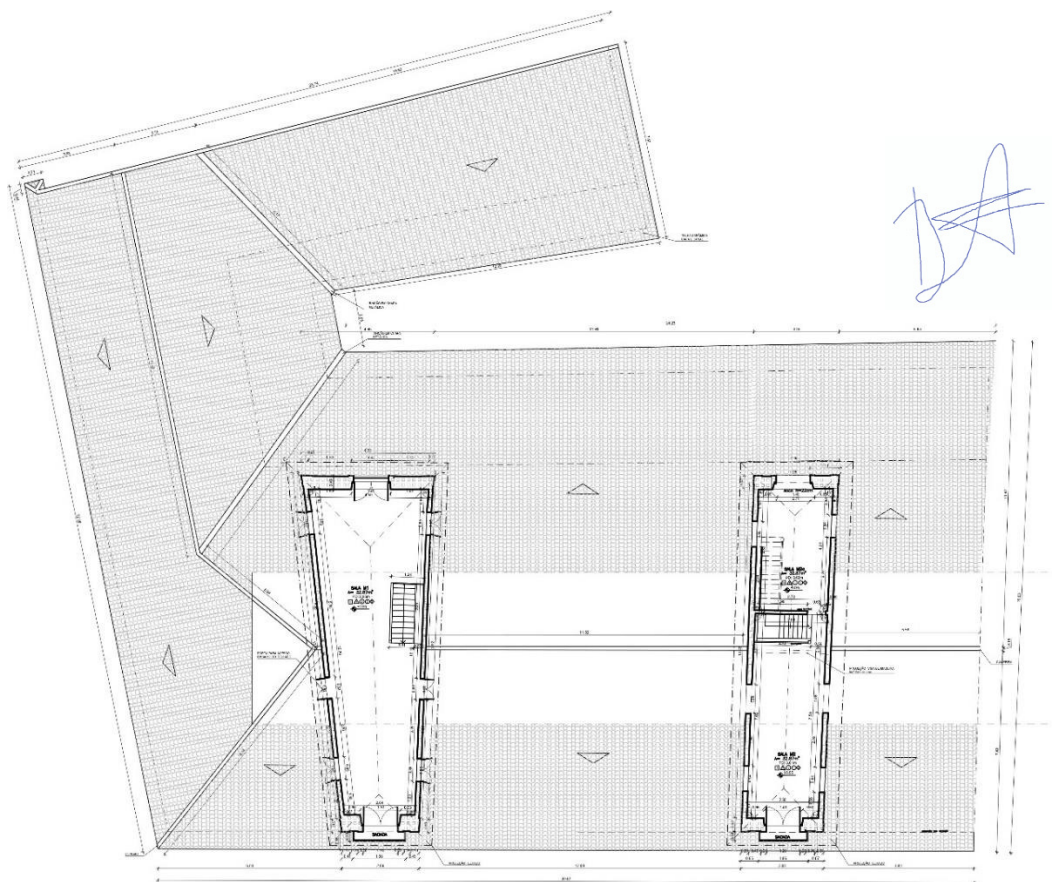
Planta Baixa Mirante. Fonte: ARCHI 5, 2017.
